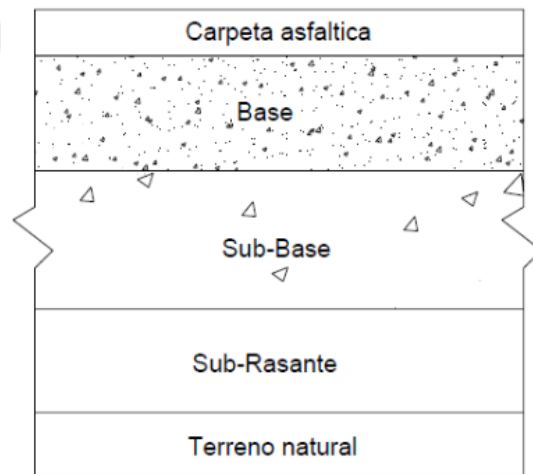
Estructura típica de pavimento. Fuente (Manual de carreteras, 2013)
